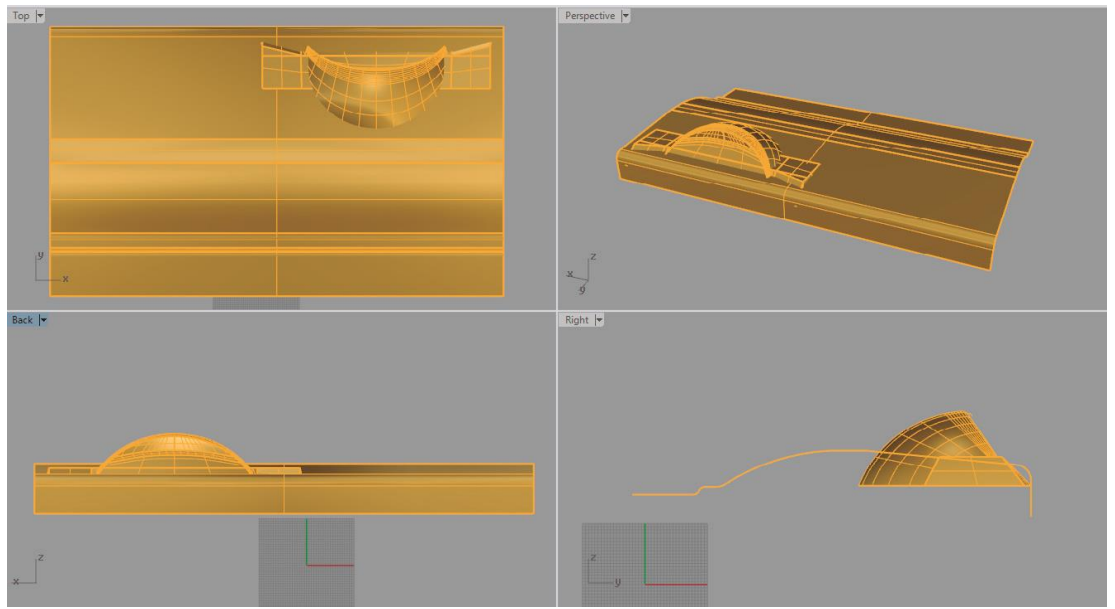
Primer prototipo virtual montado en la propuesta de estructura.
